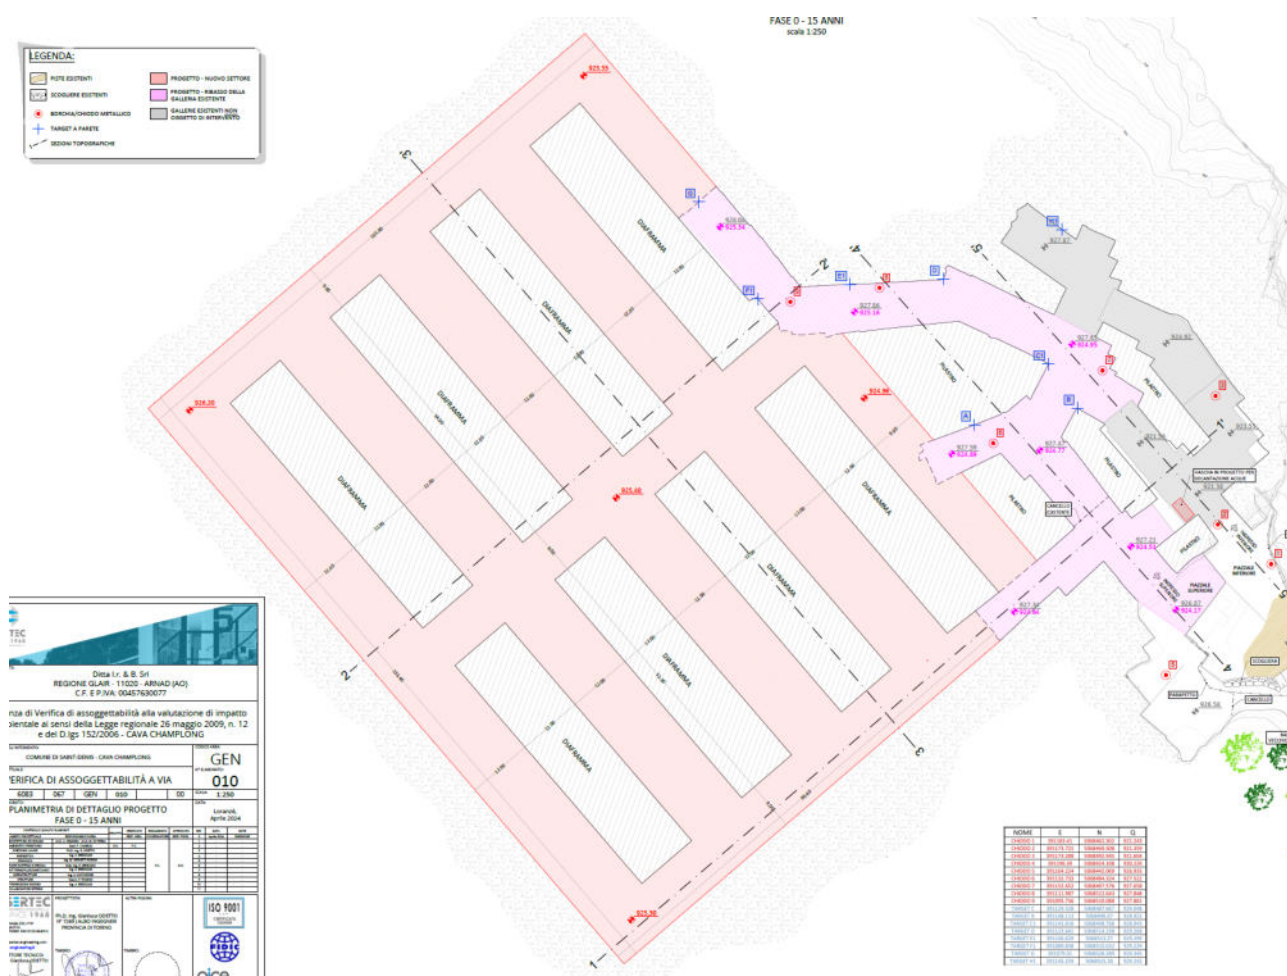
Stralcio di planimetria di progetto con schema di coltivazione a camere e diaframmi.
